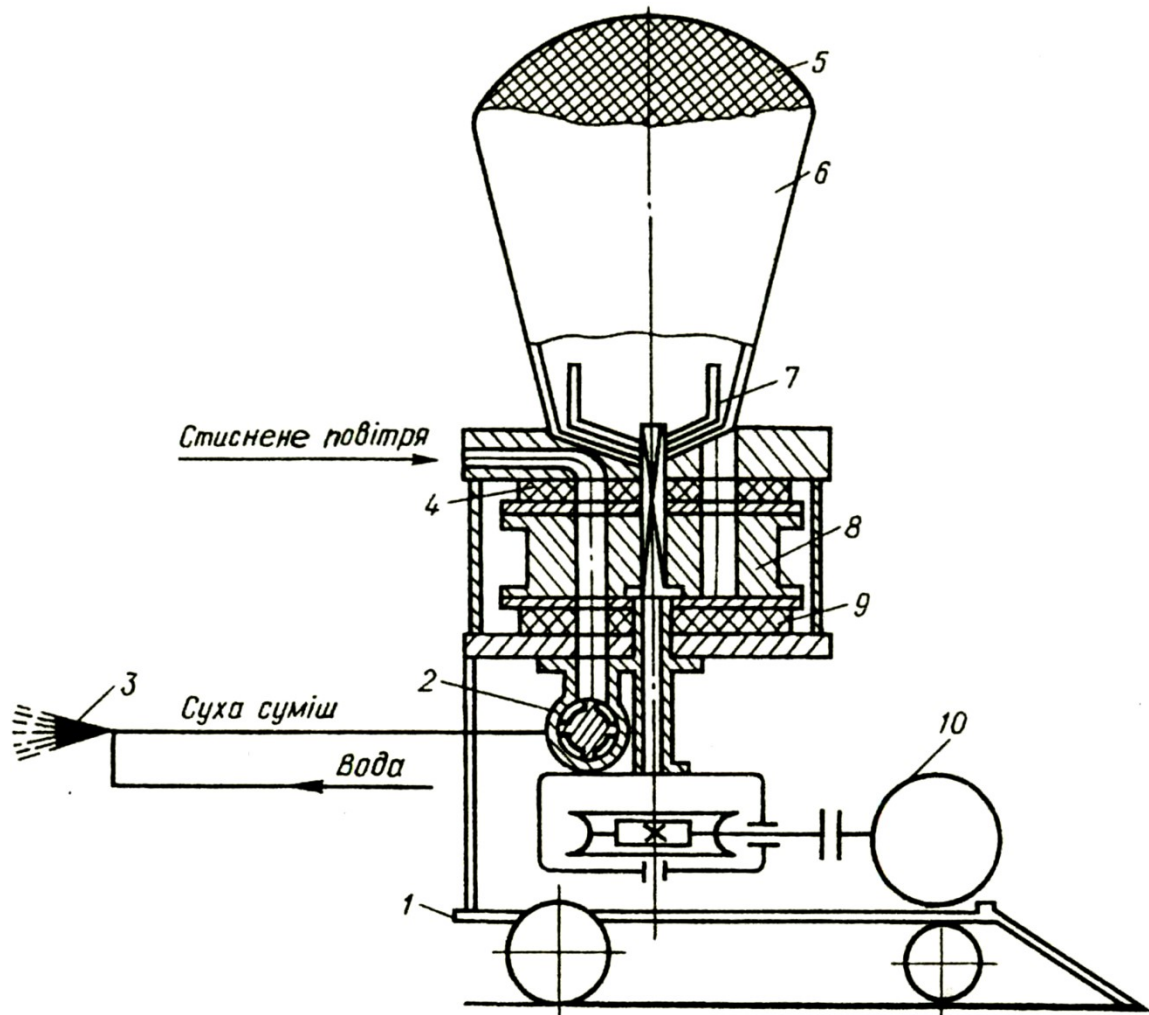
Конструктивна схема торкрет-установки: 1 - візок; 2 - крильчастий дозатор; 3 - сопло; 4 - верхній ущільнювальний диск; 5 - сітка; 6 - бункер; 7 - збудник; 8 - шлюзовий барабан; 9 - нижній ущільнювальний диск; 10 - електродвигун з редуктором
